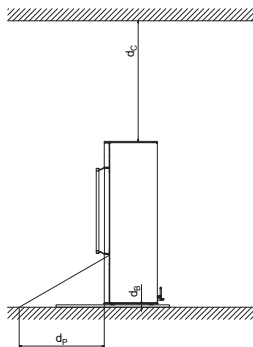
MODENA – avstand til brennbare materialer; generell sideplan av oppstillingen
